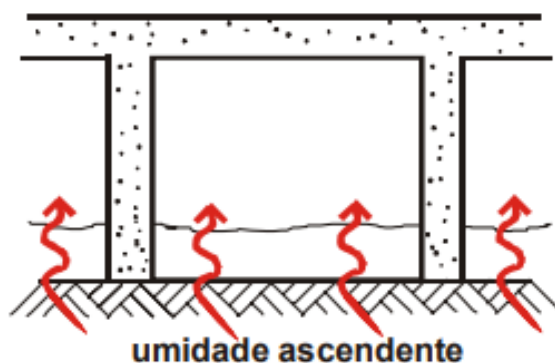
Fissura horizontal junto a base da parede (DUARTE, 1998).
